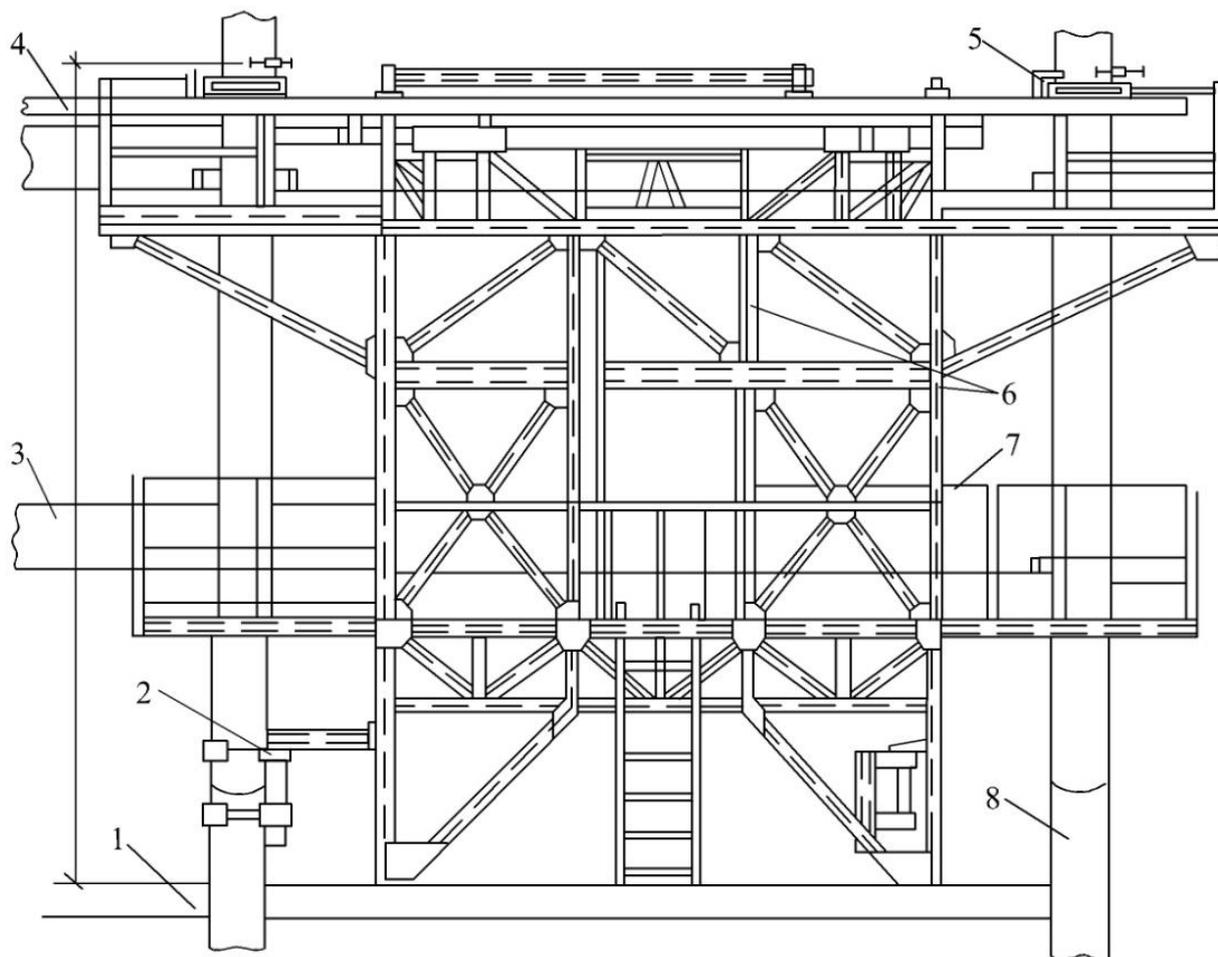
Групповой кондуктор для монтажа каркасов многоэтажных домов:
